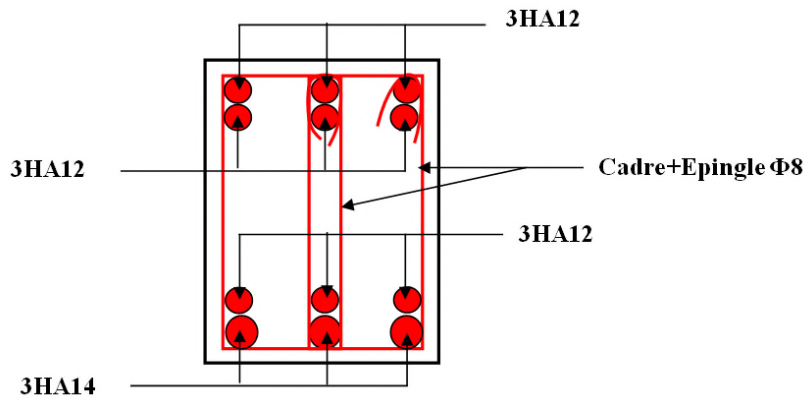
schéma de ferrailage de la poutre palière RDC
